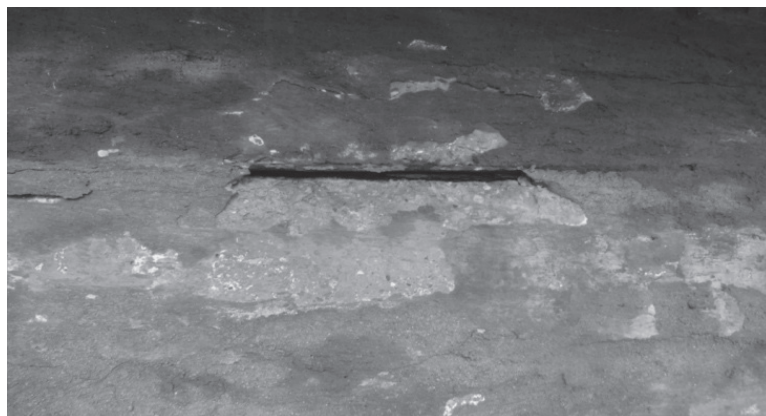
Определение степени карбонизации бетона ребра балки Б7 пролета 7–8
